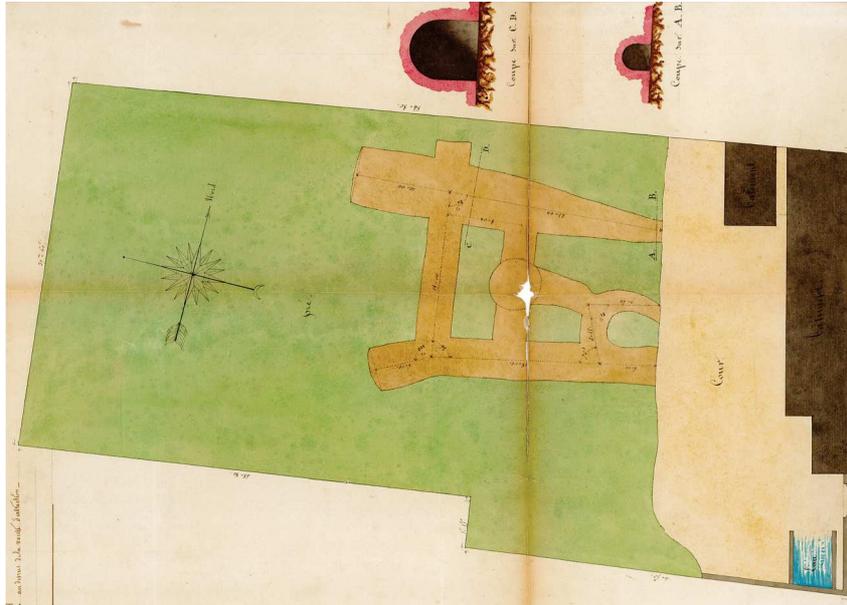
Extrait du plan de la carrière au 30/06/1849 établi par un géomètre
